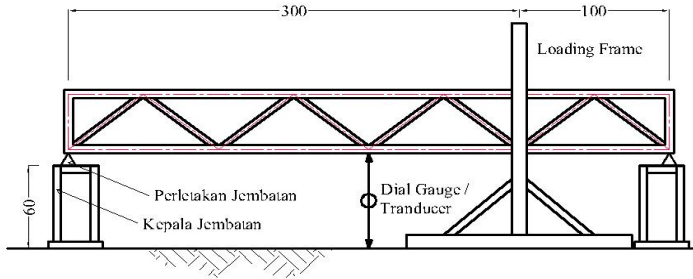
SKEMATIK GAMBAR SITE PLAN KOMPETISI
